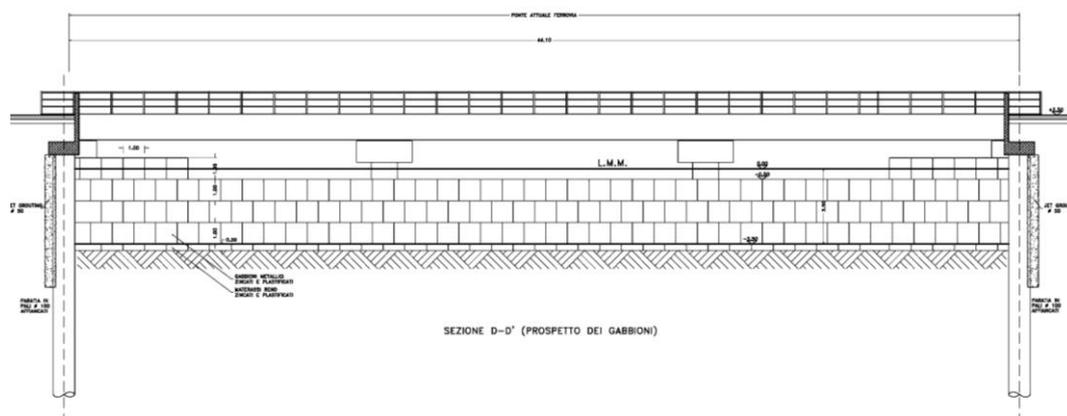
Tratto tombato Fosso della Fiumaretta: prospetto imbocco.
